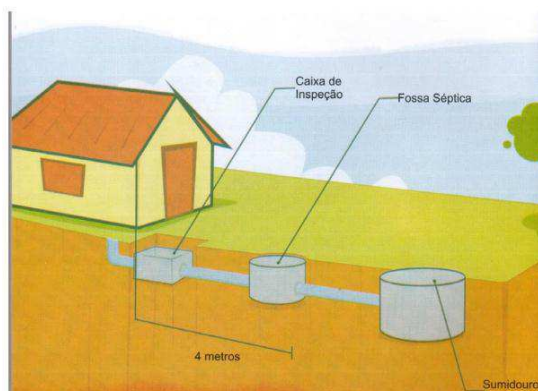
Fossa Séptica - CAESB – Instruções para instalação de fossa séptica e sumidouros em casa
